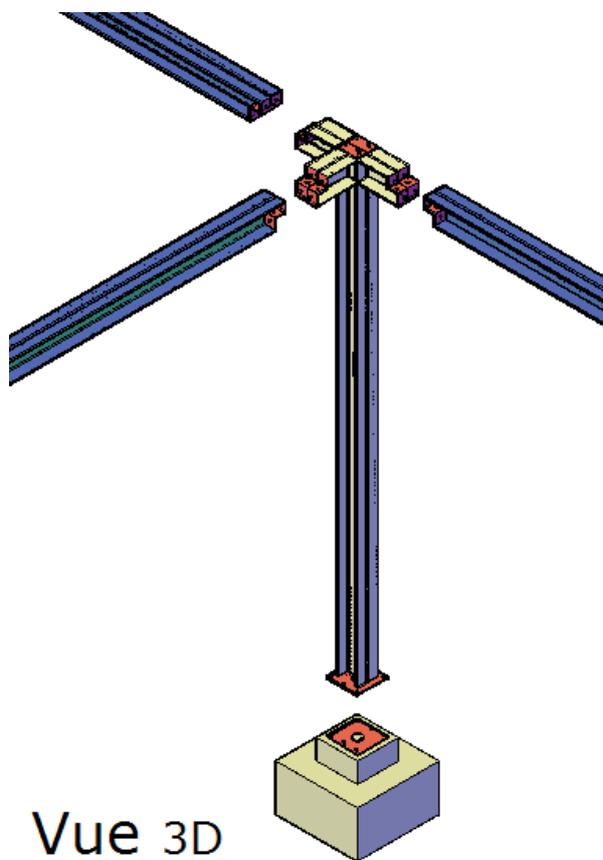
Detail assemblage poteau de rive avec poutre et semelle
